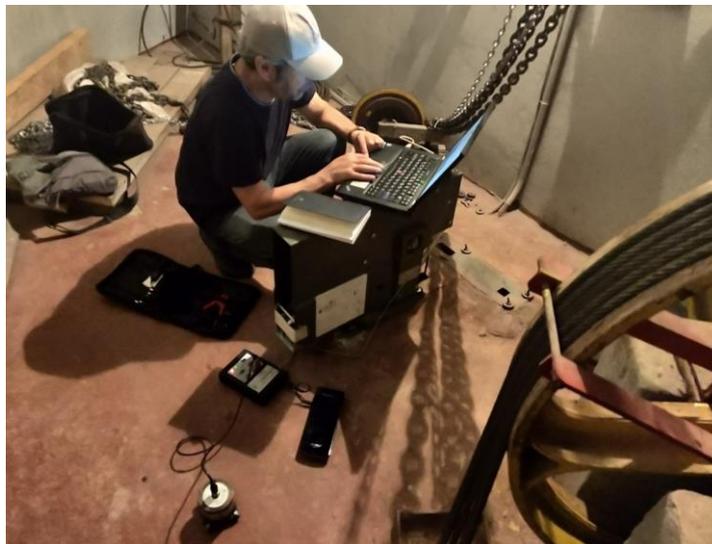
Пункт сбора динамических данных на отм. +144,50 м в железобетонной части башни
